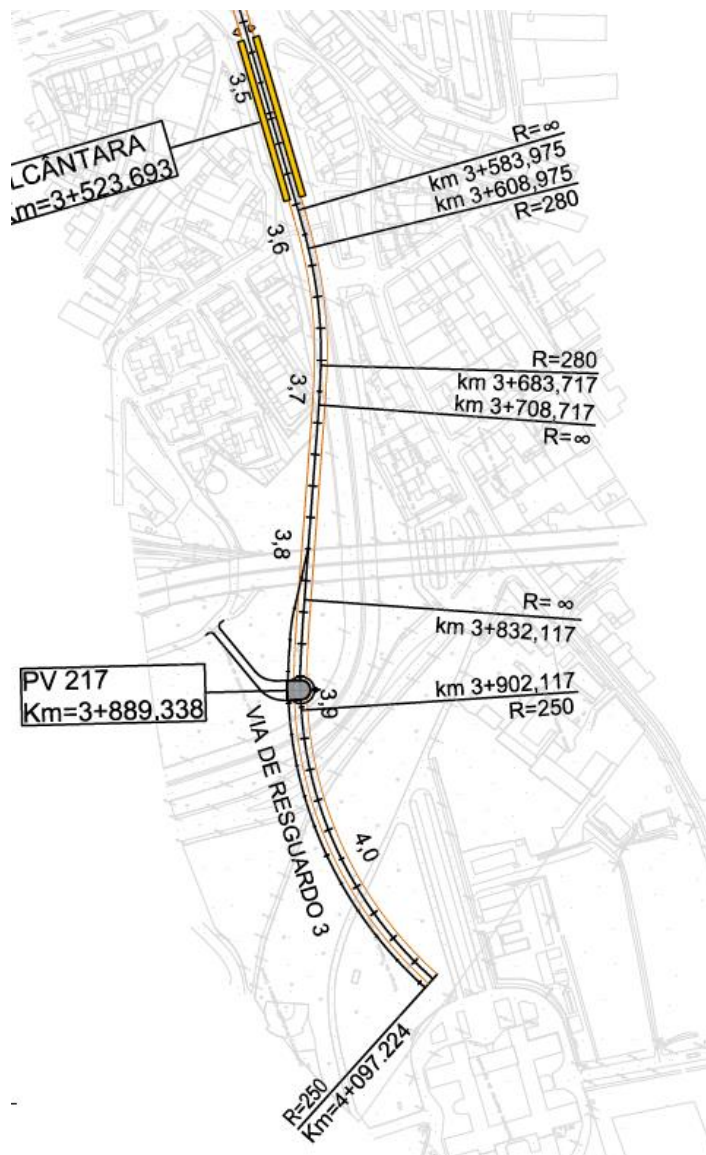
Traçado em planta – 81º Troço: Término - Alcântara
